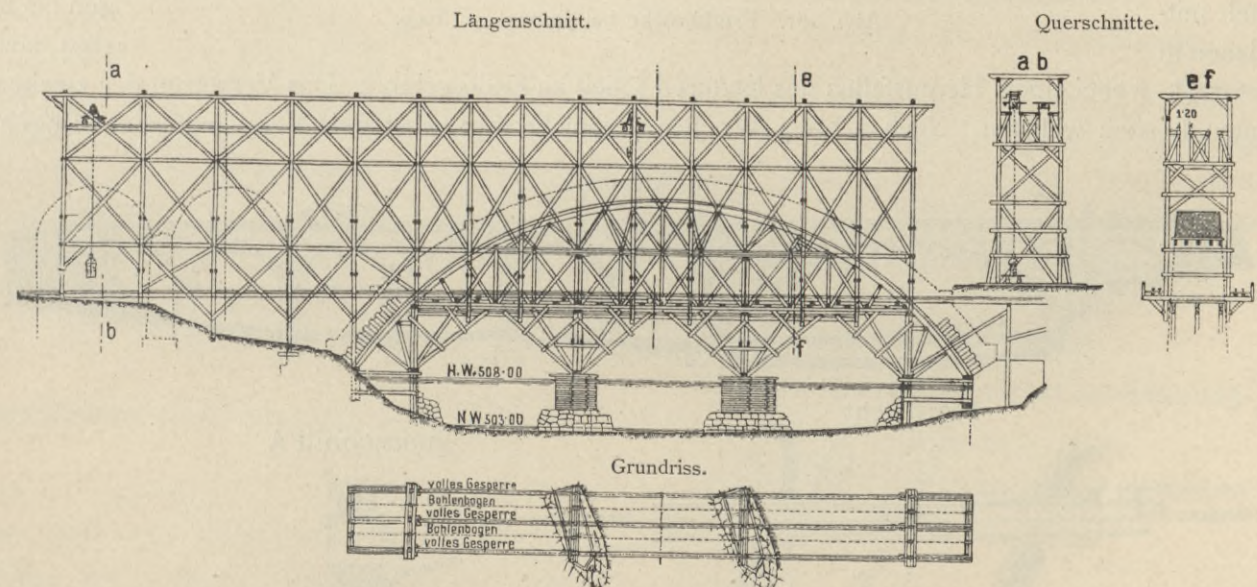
Gerüste, behufs Gewölbequader-Versetzung für die Pruthbrücke bei Jaremcze. 1:1000.
